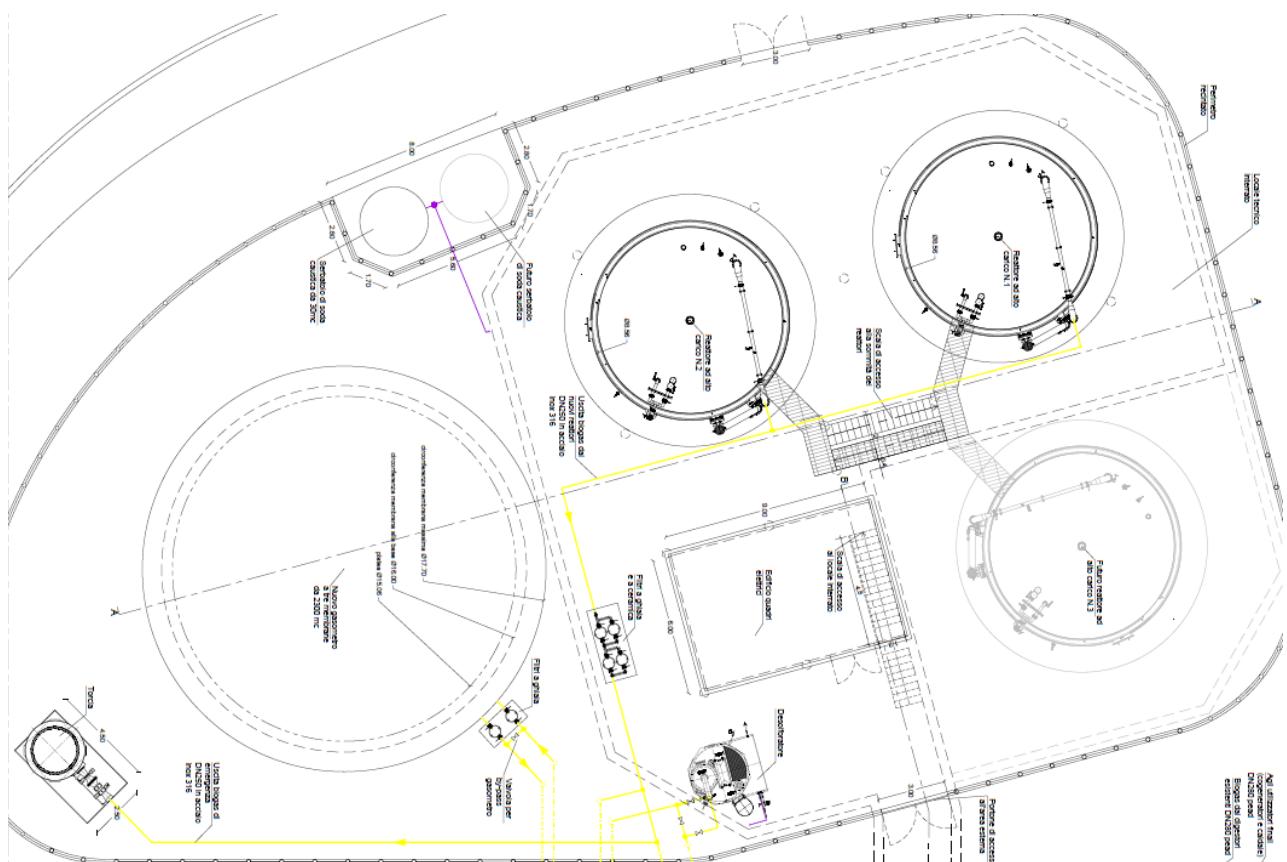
Grundriss Bereich Gasometer und Reaktoren / planimetria zona gasometro e reattori
